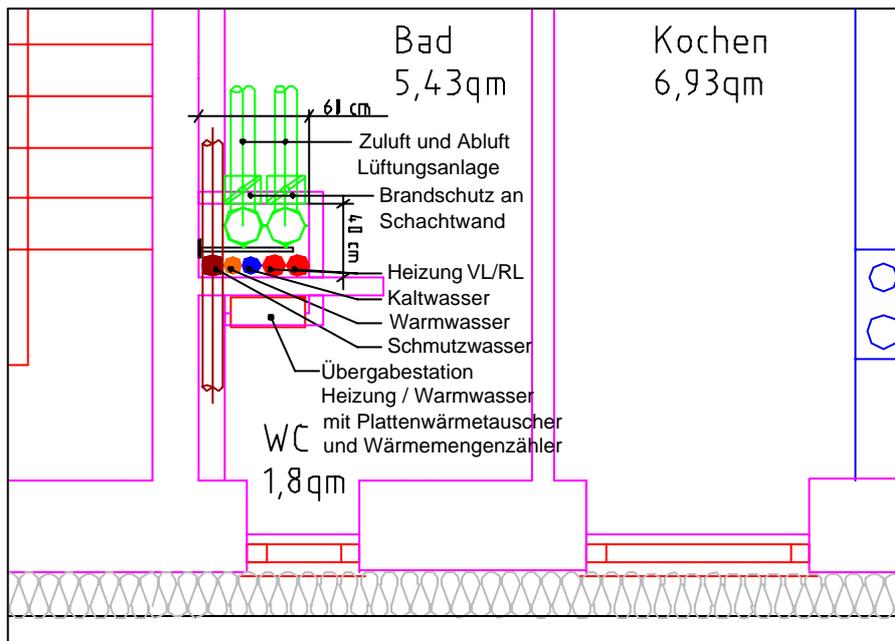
Beispiel für die Erschließung einer Wohnung im Geschosswohnungsbau mit einem gemeinsamen Installationsschacht für Heizung, Lüftung und Sanitär.
